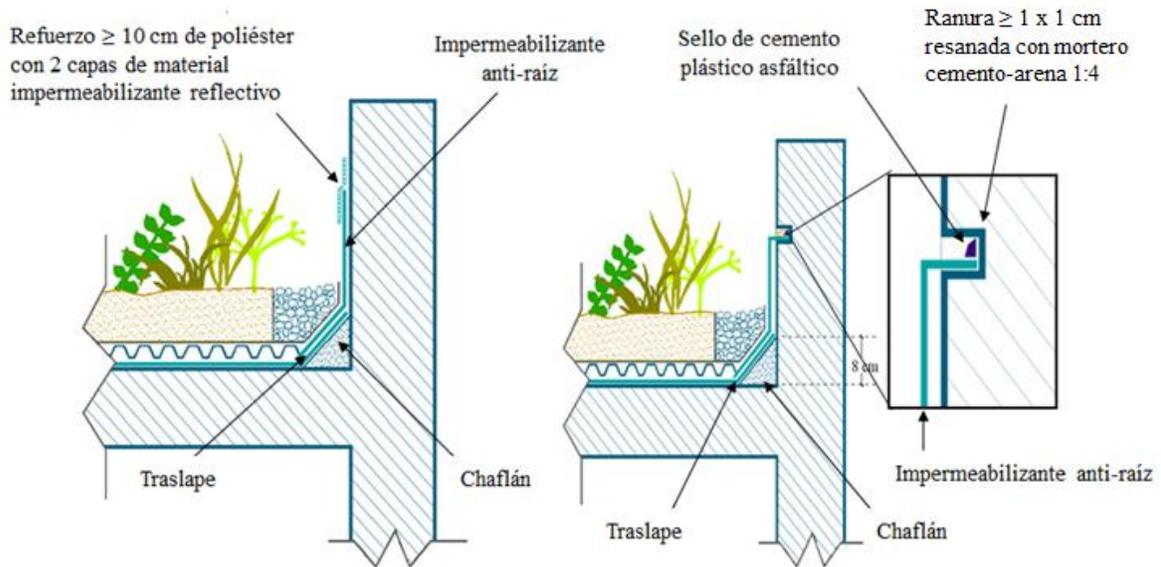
Impermeabilización con membrana prefabricada asfáltica en puntos de encuentro con pretilas y elementos emergentes perimetrales.
